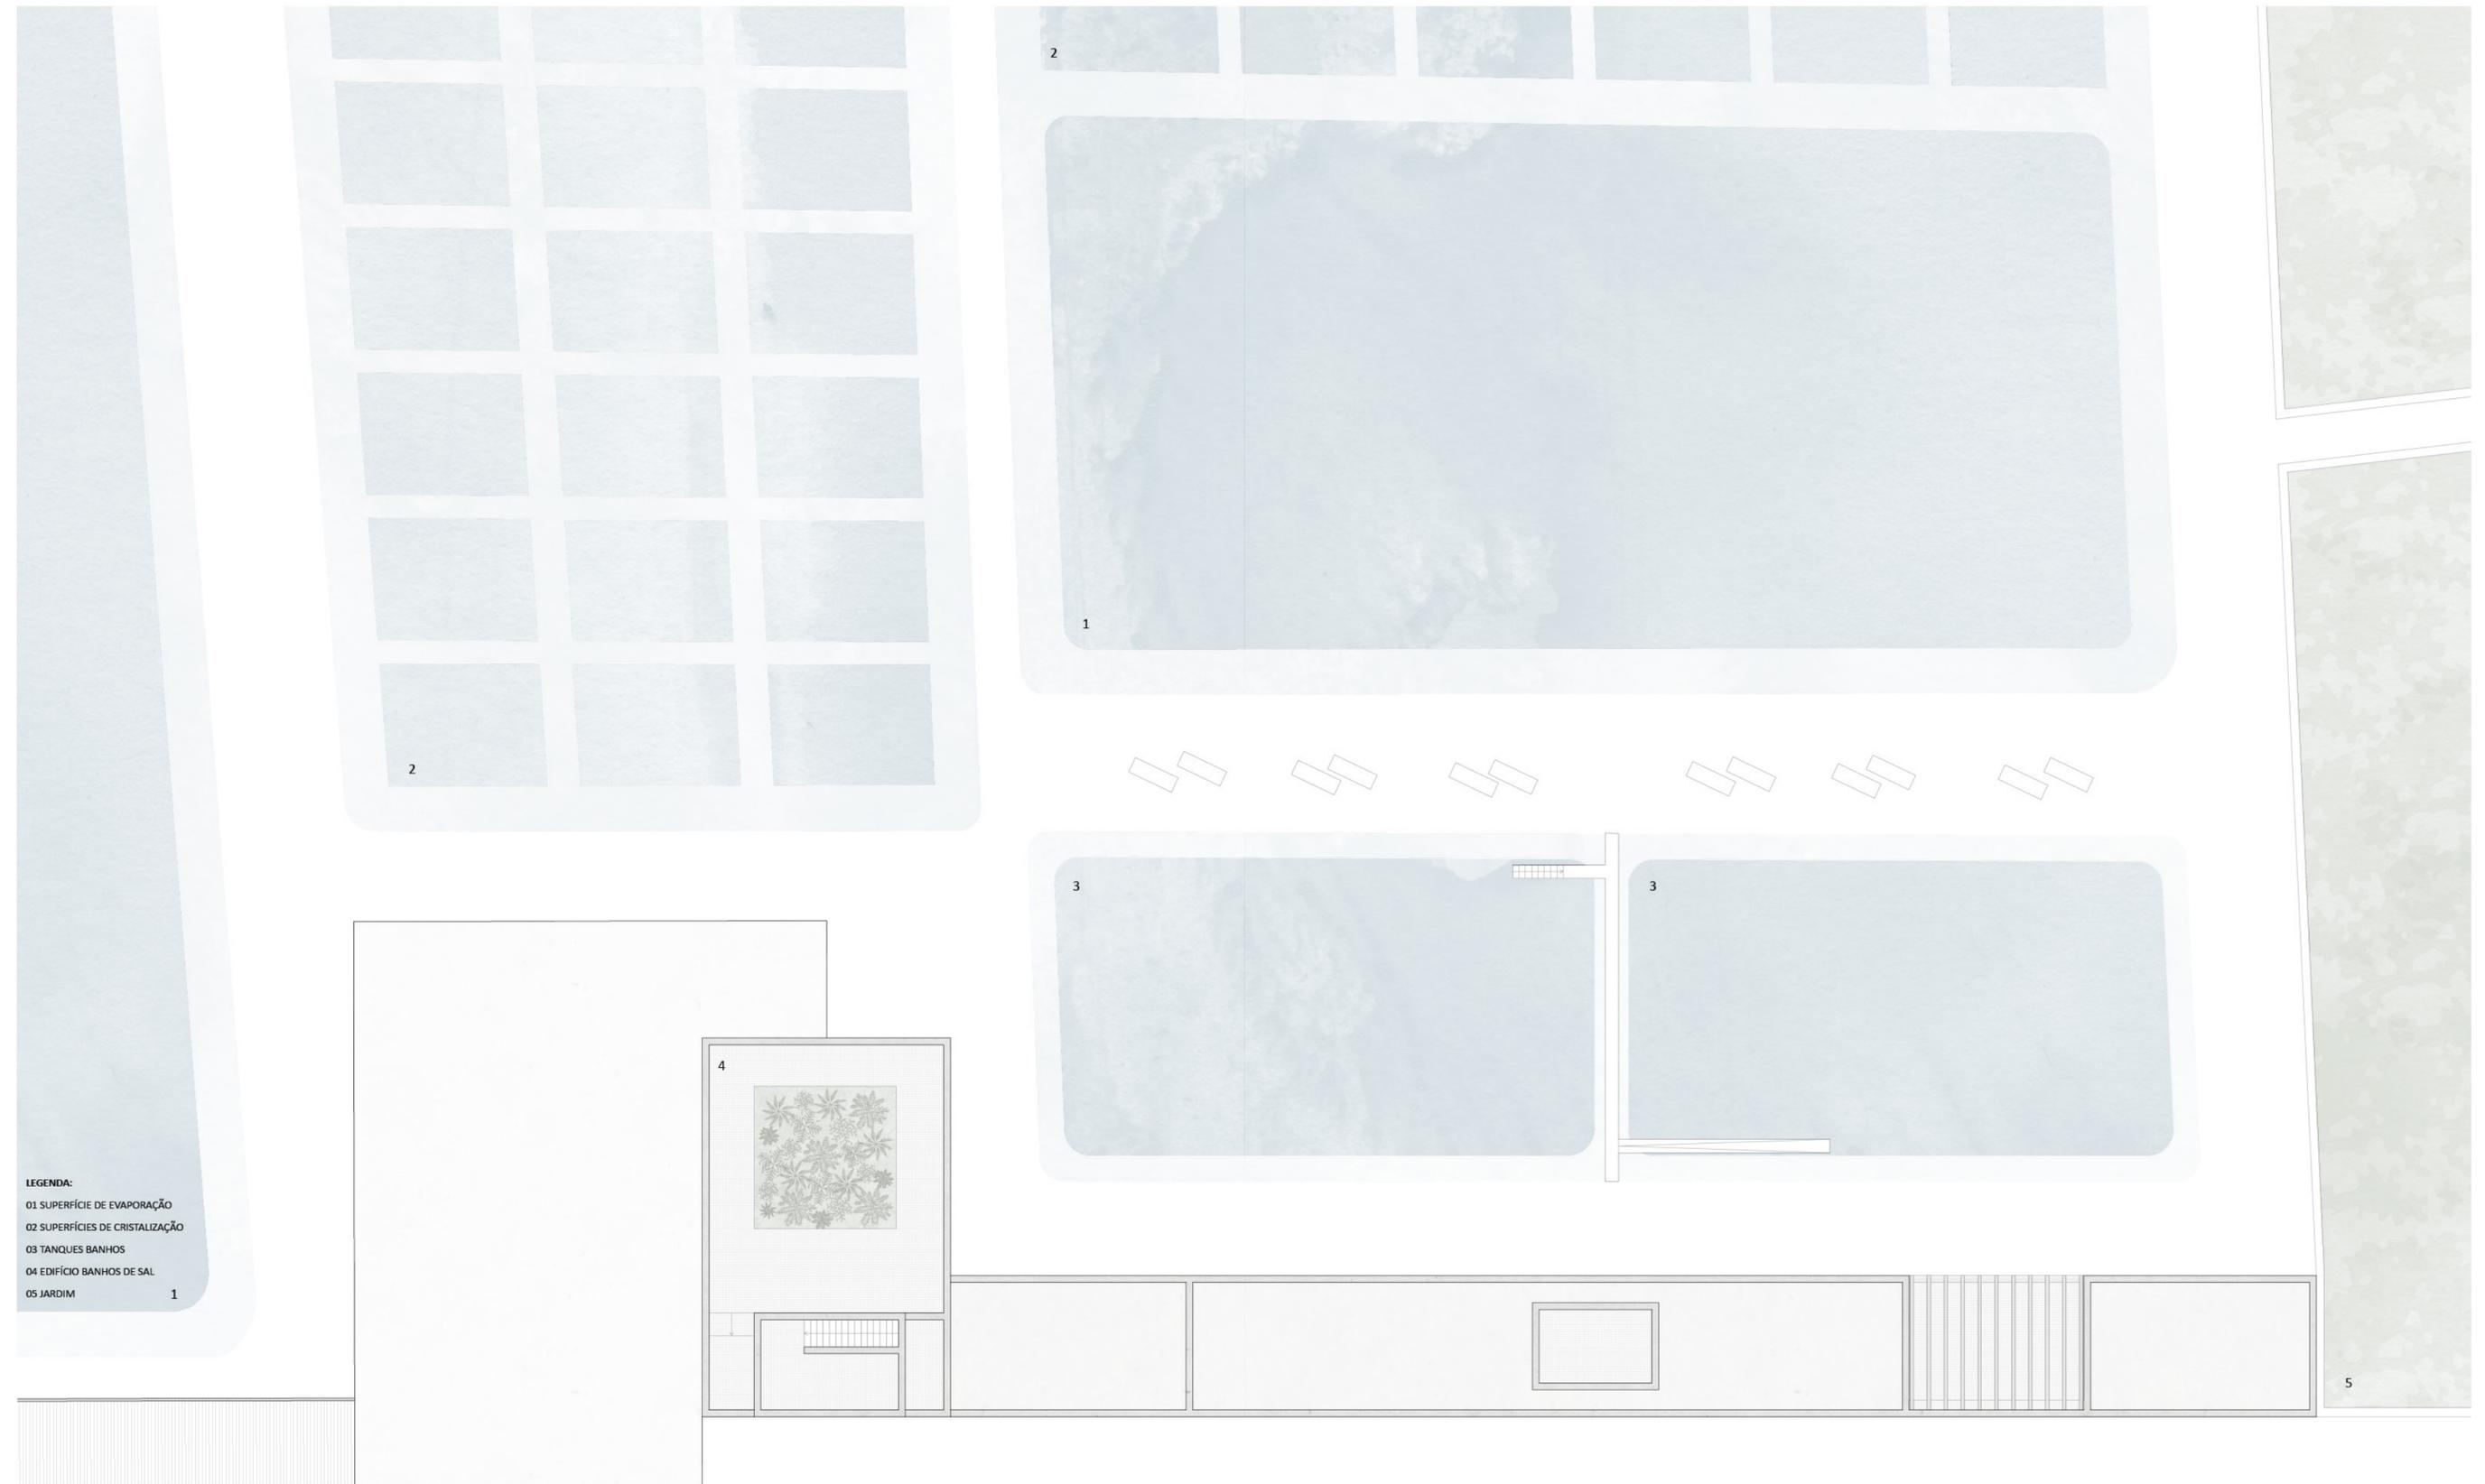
PLANTA DE COBERTURAS | EDIFÍCIO BANHOS DE SAL
